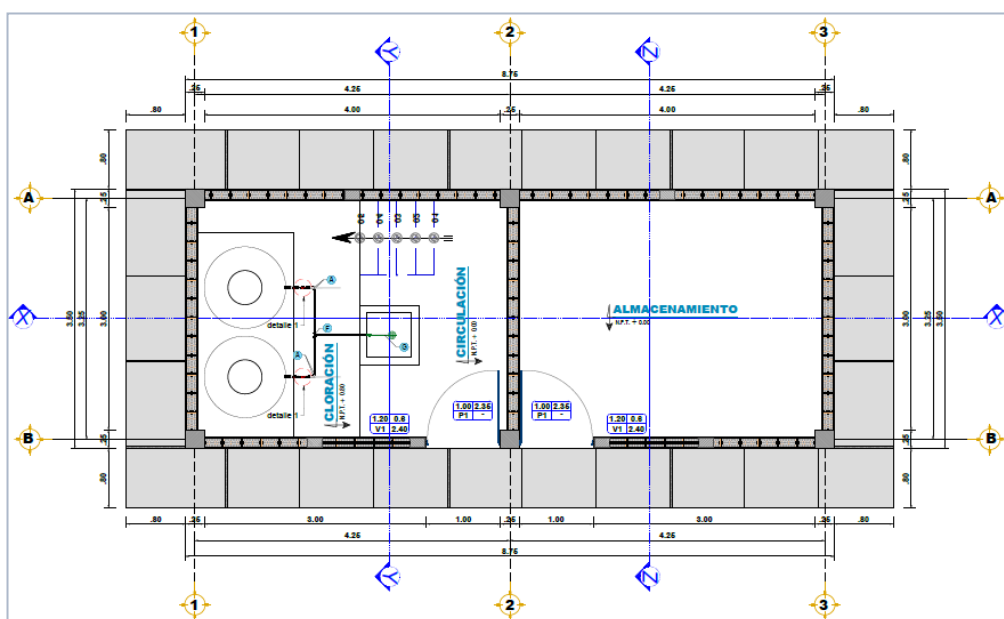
CASETA DE CLORACION Y ALMACENAMIENTO PLANTA
